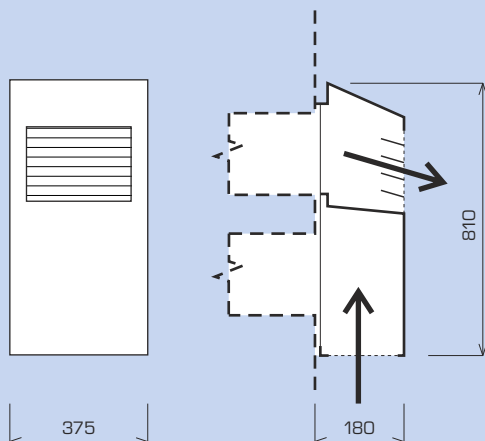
## DETAIL INSTALACE A FASÁDNÍCH PROSTUPŮ
